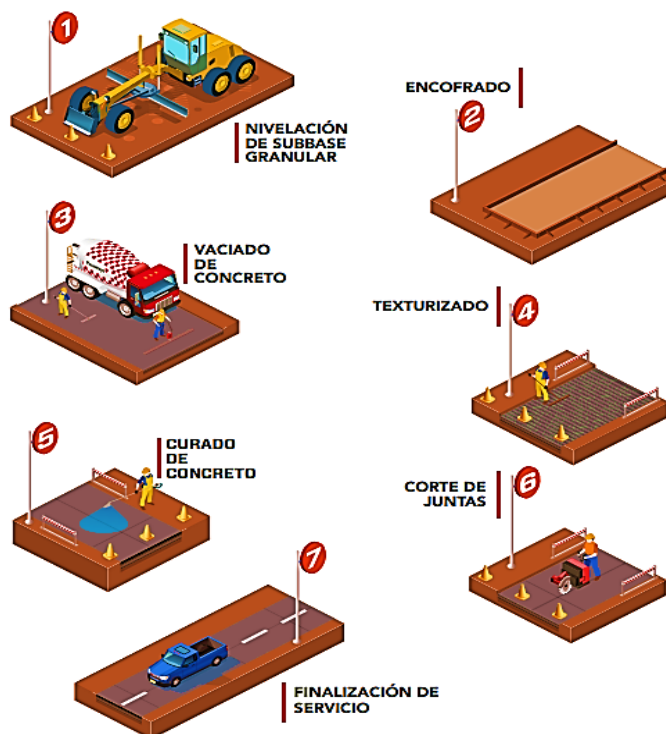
Procedimiento constructivo de una Pavimentación Rígida. Fuente: pavimentos rígidos (storage.googleapis.com)
